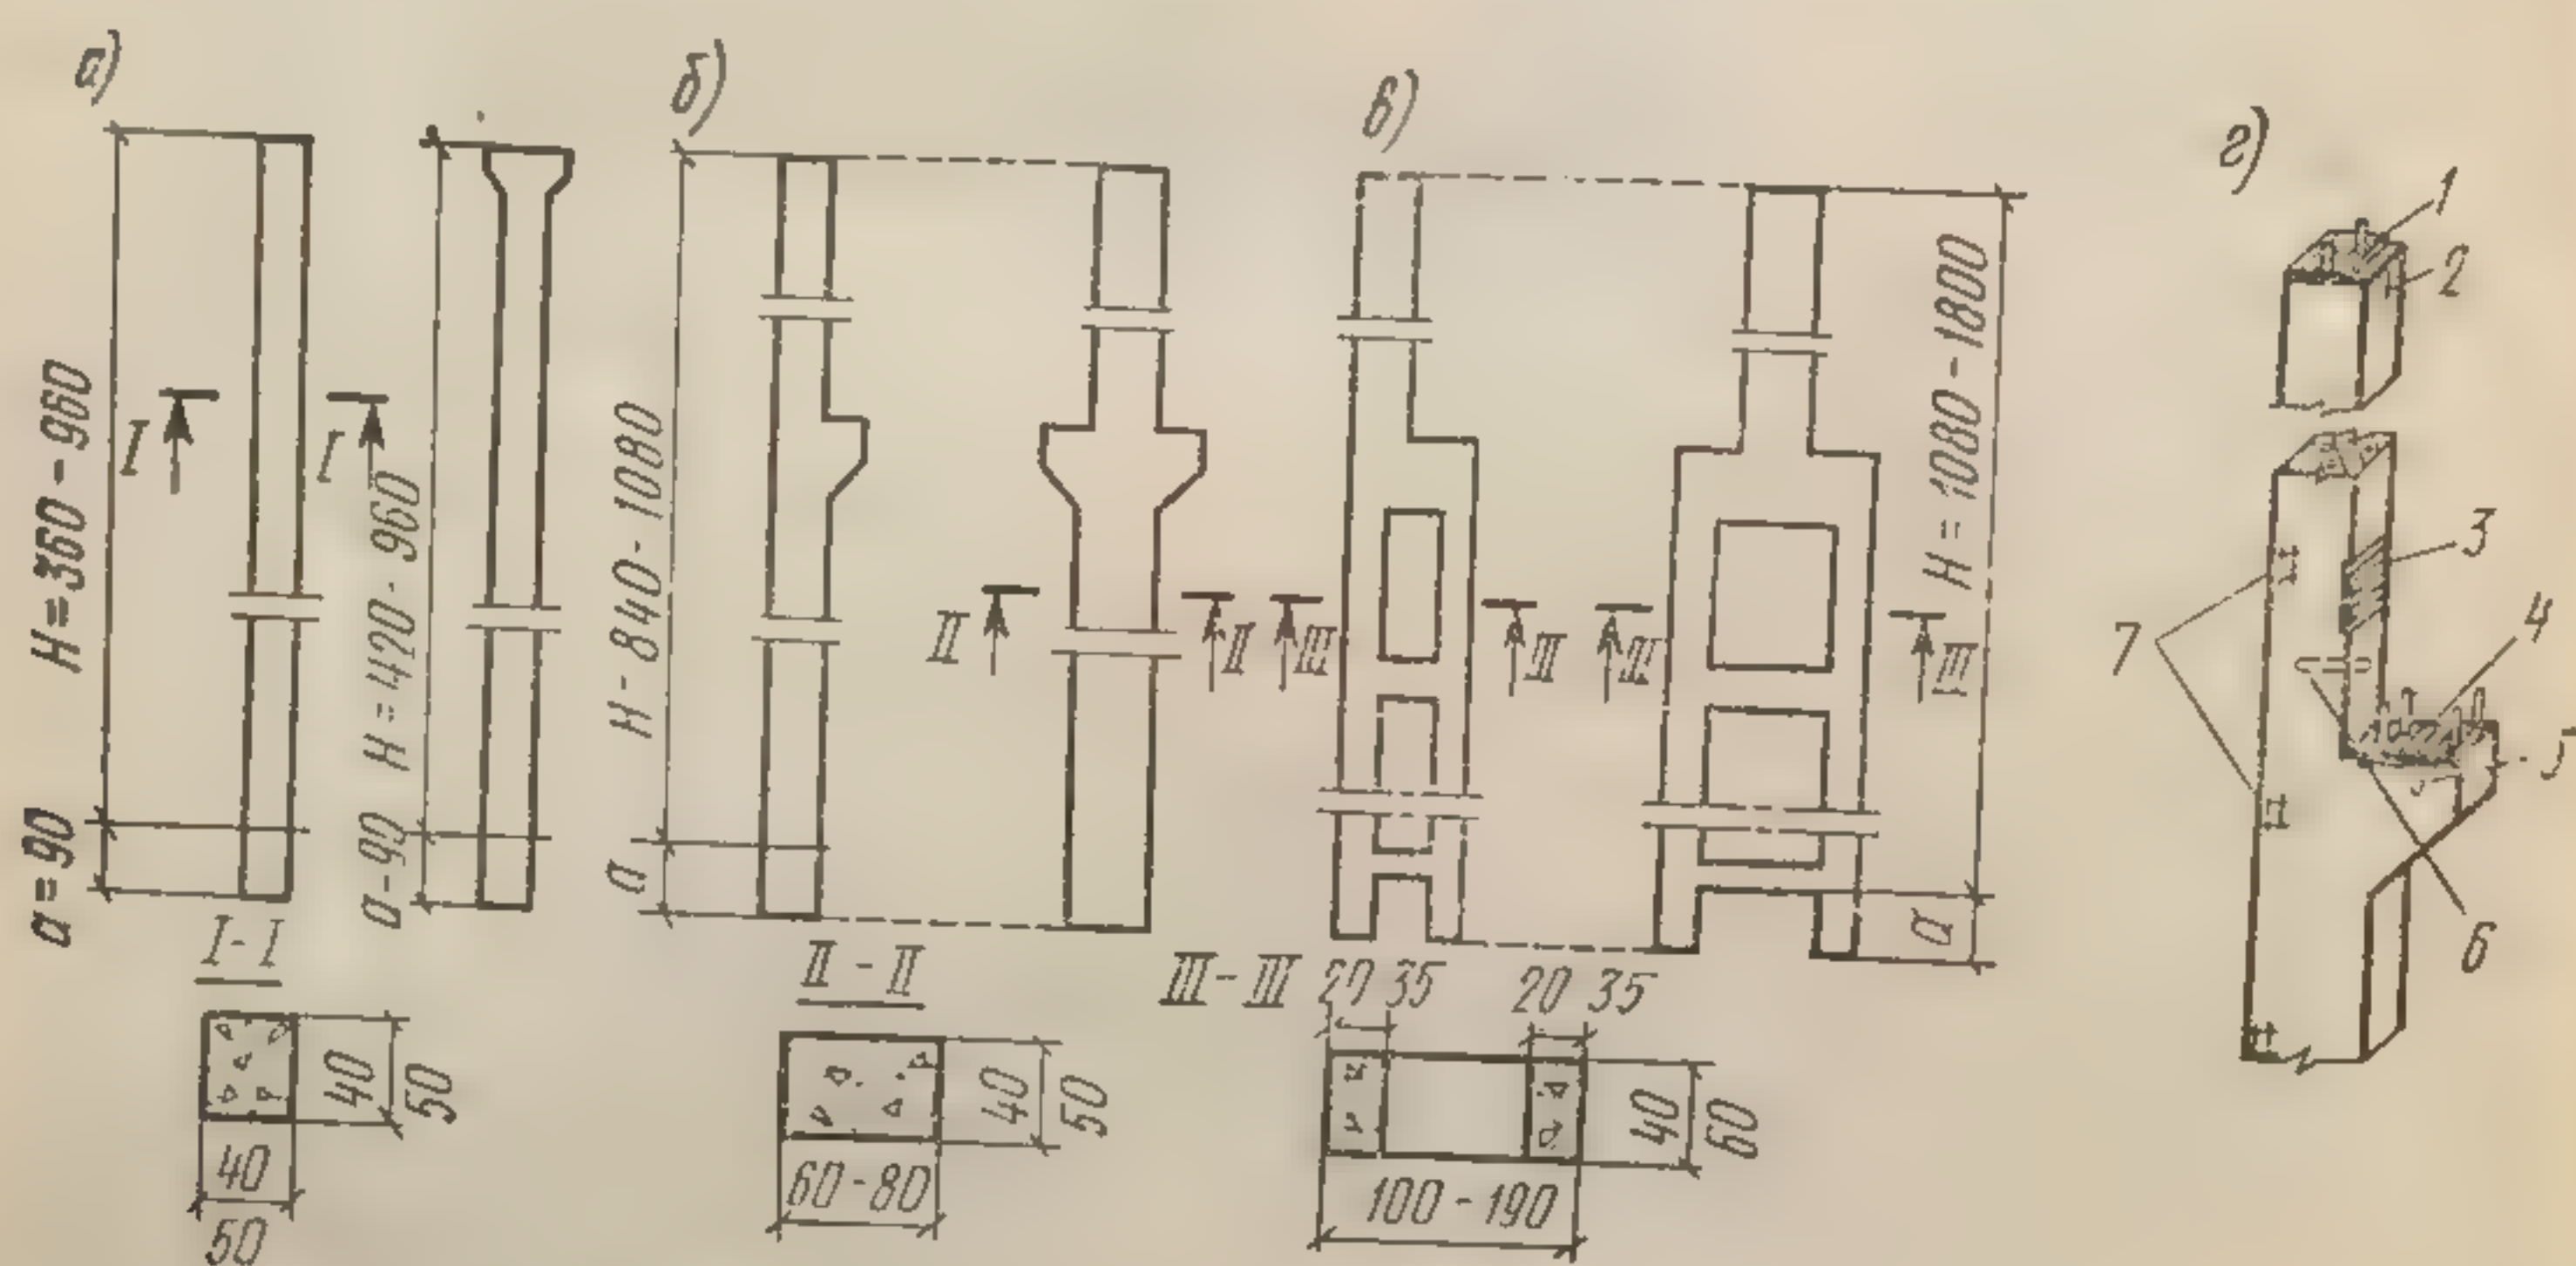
Сборные колонны одноэтажных промышленных зданий:
